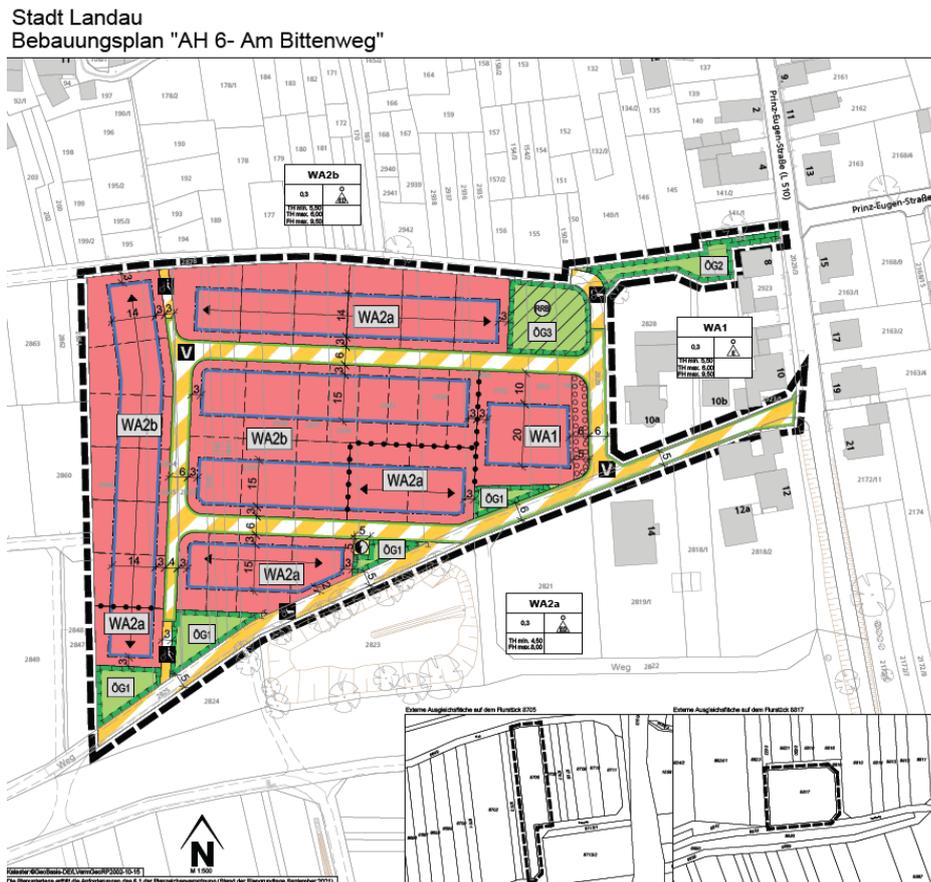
Entwurf Bebauungsplan AH6, April 2022.
